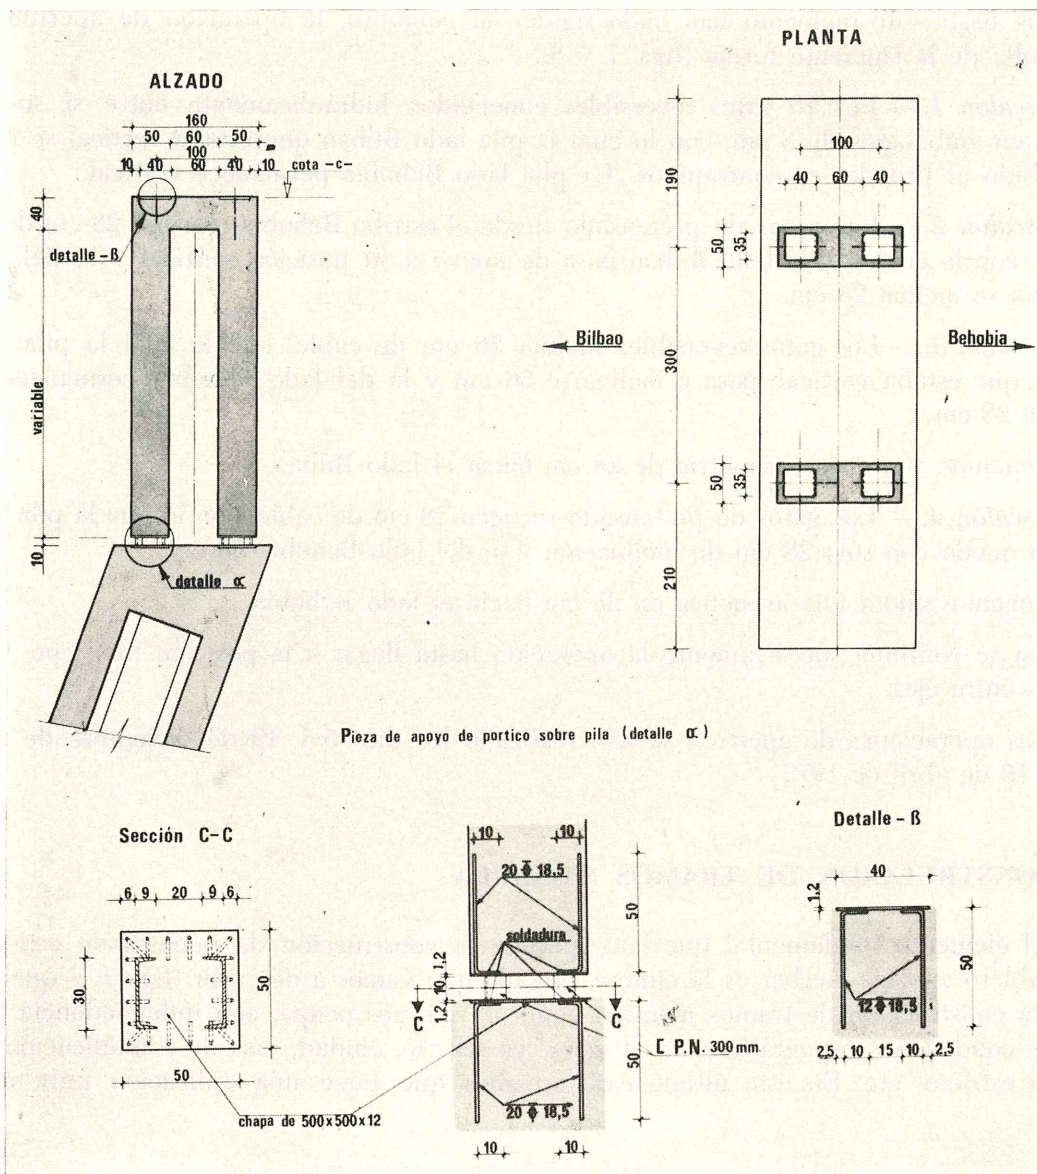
Detalle de pórticos de apoyo de los métodos de la cimbra.
